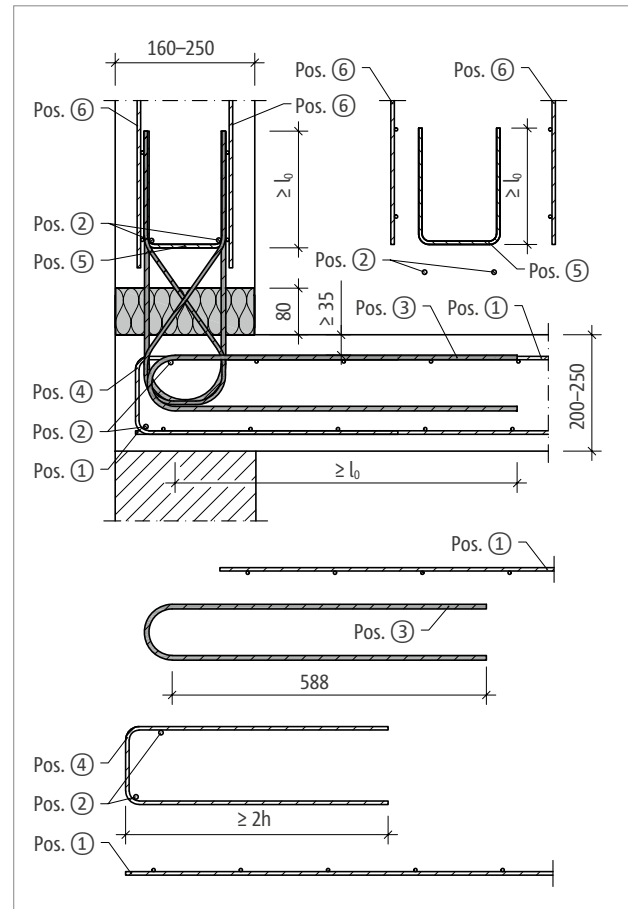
Schöck Isokorb® T Typ A: Bauseitige Bewehrung außenliegend
